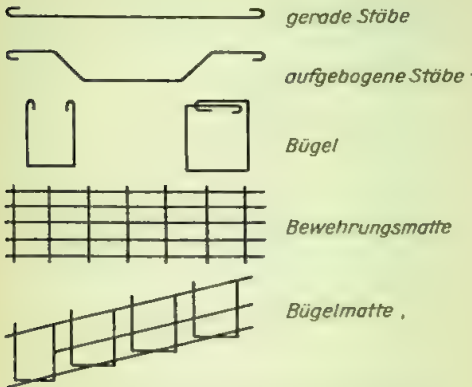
Grundformen von Bewehrungsstäben
